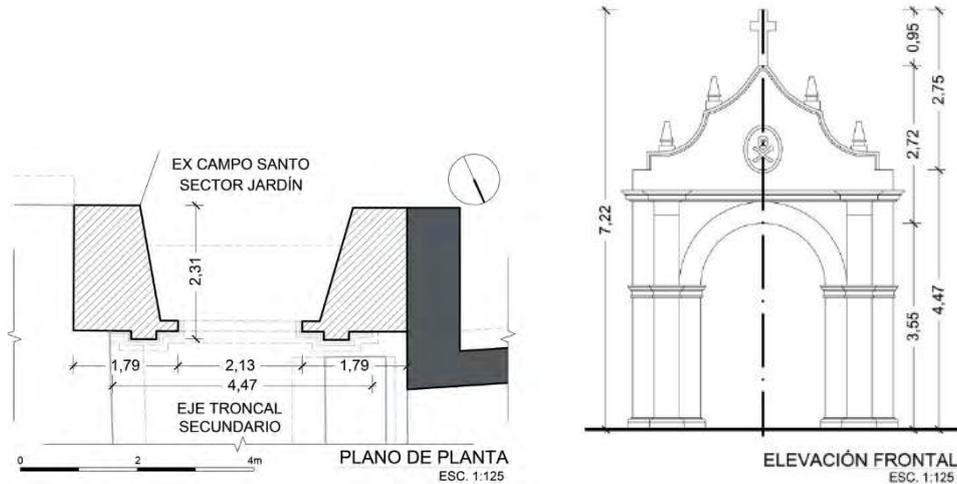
Plano de planta de la puerta-umbral sureste hacia el lado del sector jardín, antiguo Campo Santo. Elaboración propia
